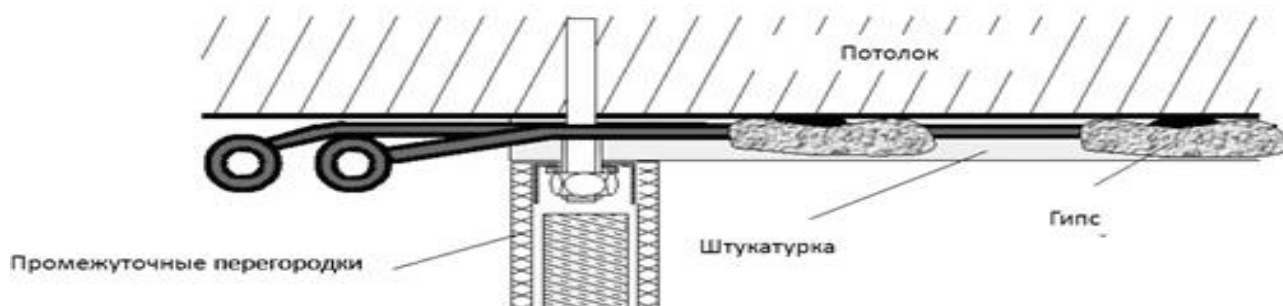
Вариант монтажа капиллярных матов на бетонное перекрытие
